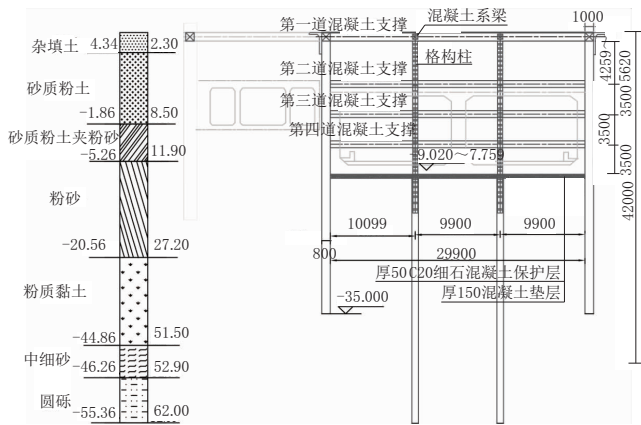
基坑围护结构的典型横断面示意图(单位:mm)
